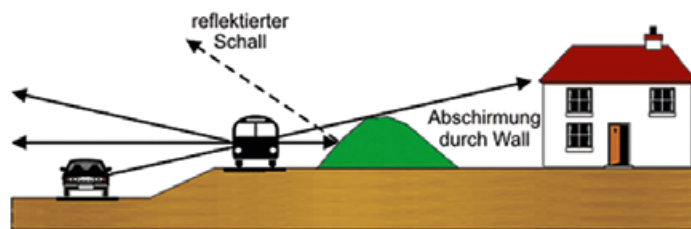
/19 Abschirmung durch Einschnittslage und Wall
